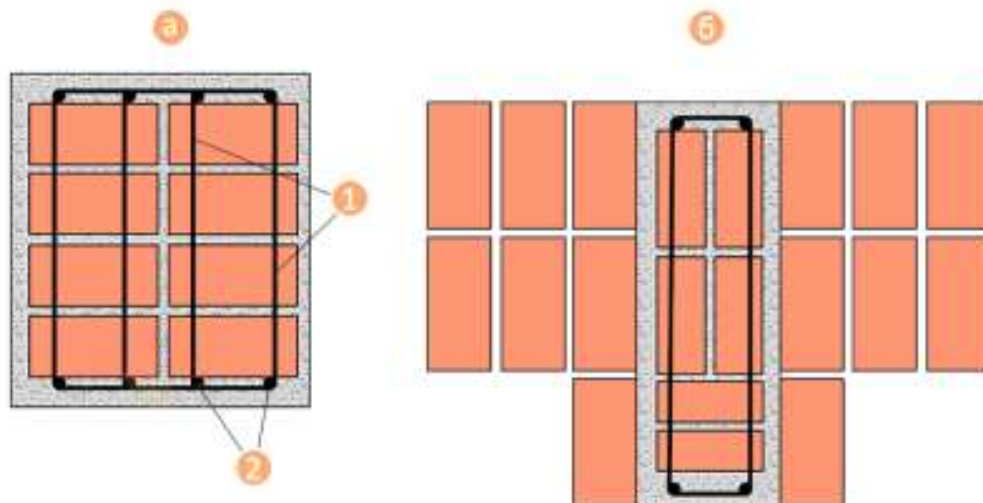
Армування: а – зовнішнє поздовжнє; б – зовнішнє в штробі; 1 – хомути; 2 – поздовжня арматура
